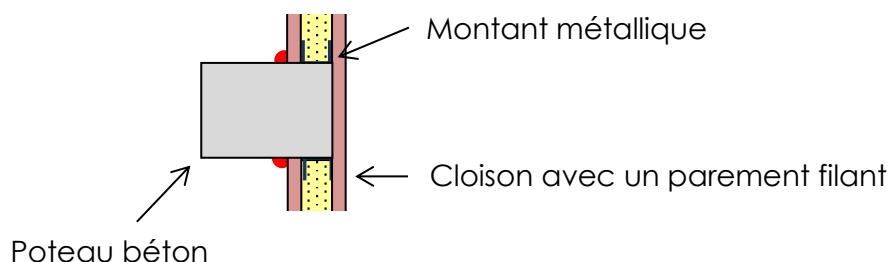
Jonction entre les cloisons légères et les poteaux béton (Plan)
